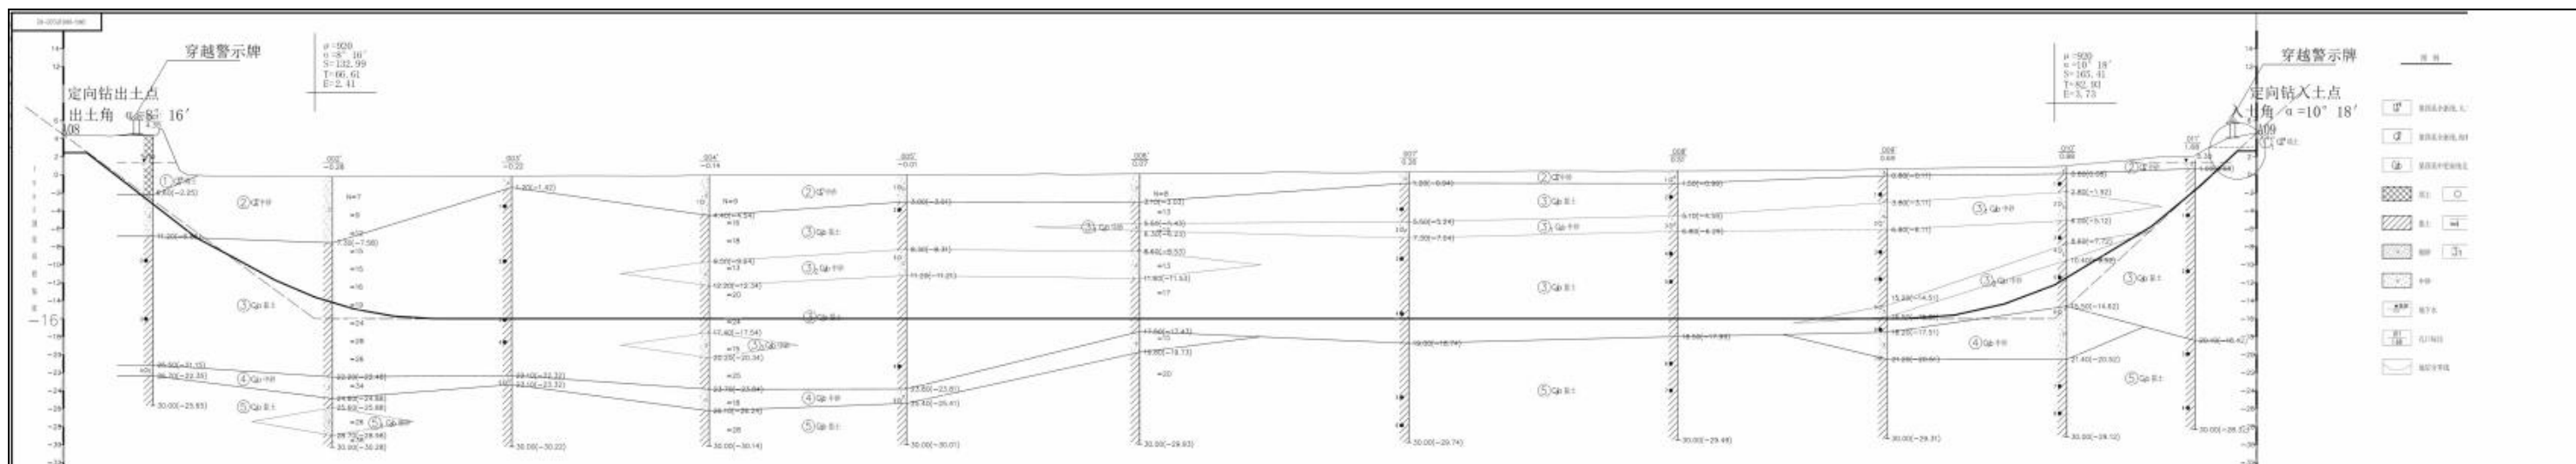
项目涉海段 1 管线定向钻穿越纵断面图
